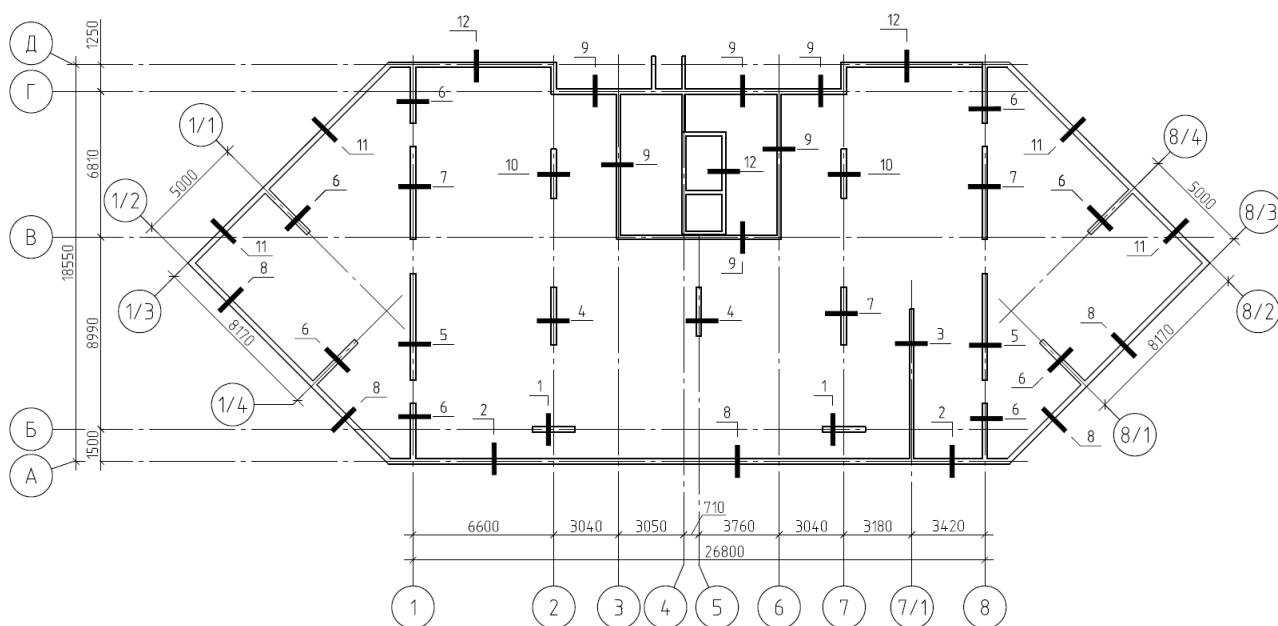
Схема расчетных нагрузок по верху ростверка
